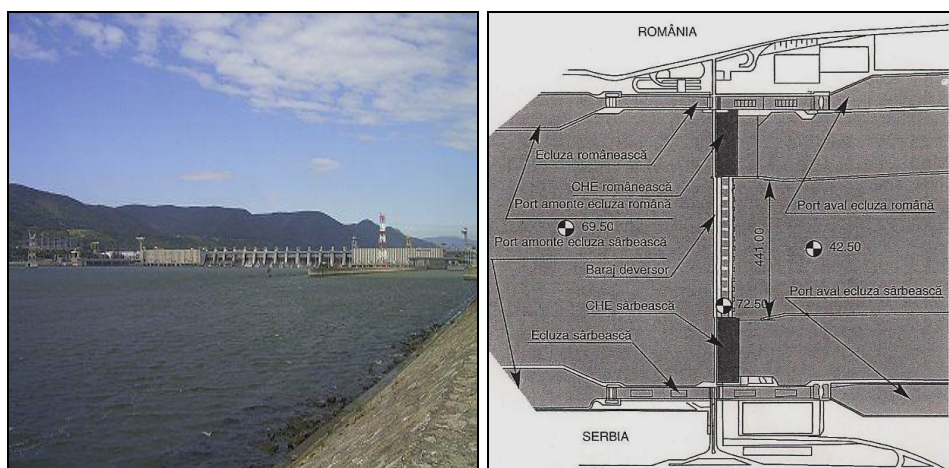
Barajul de la Porțile de Fier (foto și vedere în plan)
